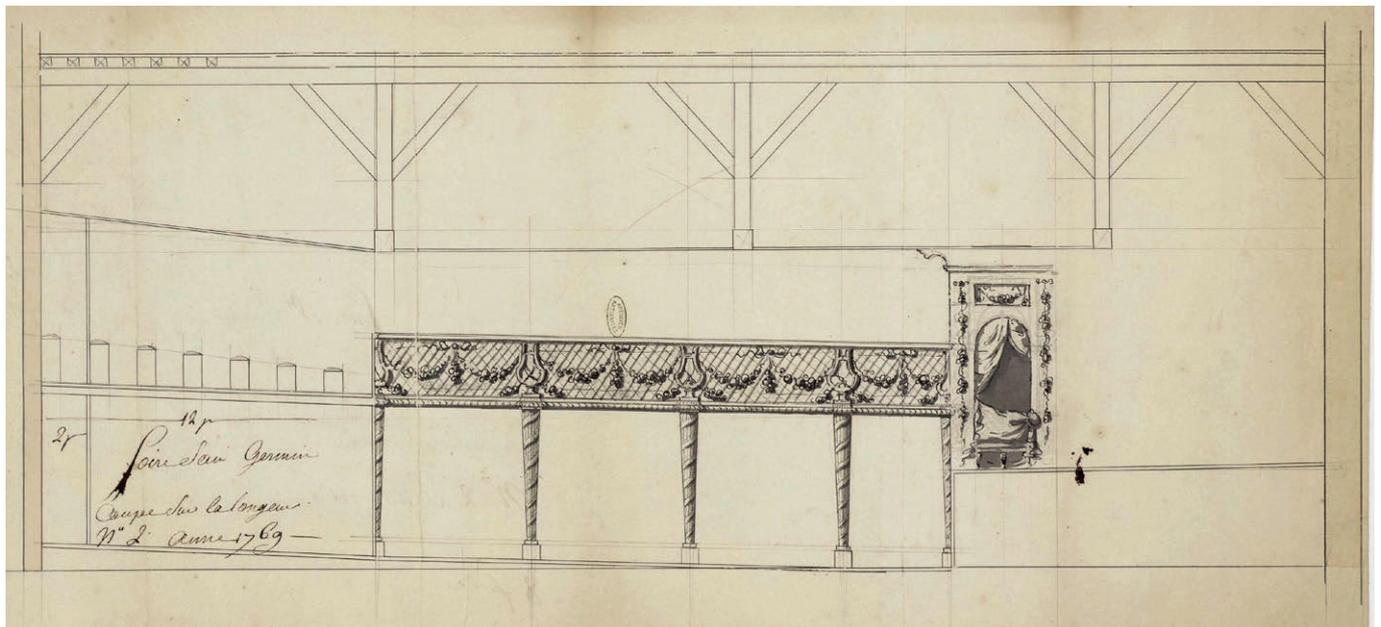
Planche A.N. N/III/Seine/259/1, montrant la coupe longitudinale du projet.
